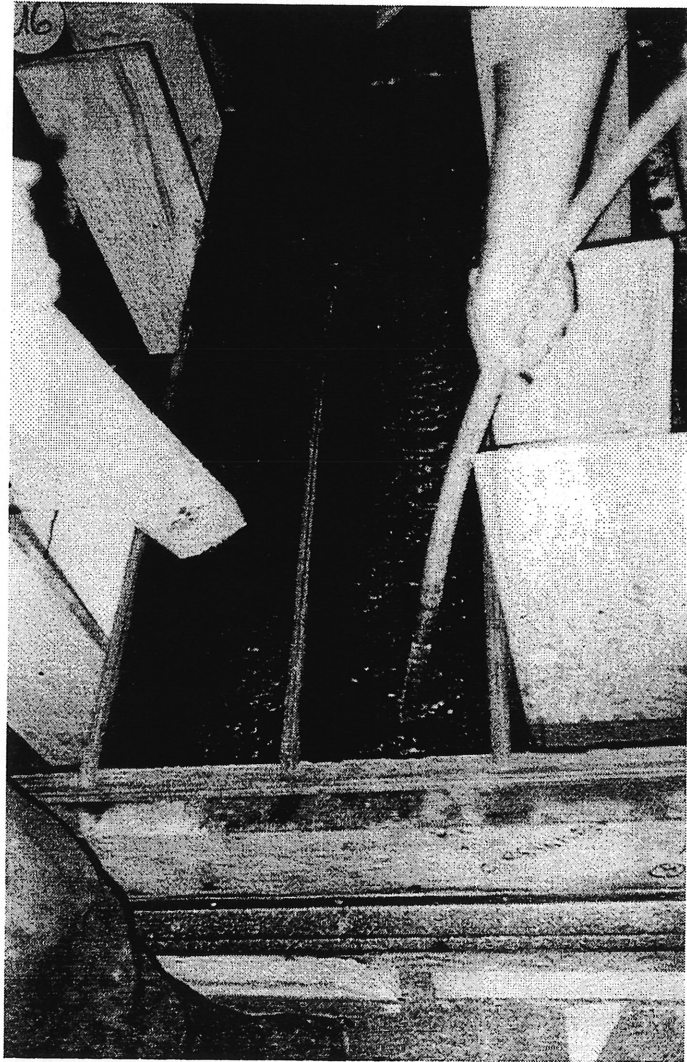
Coulage des deux poutres en BPR 2, et consolidation par vibration interne
